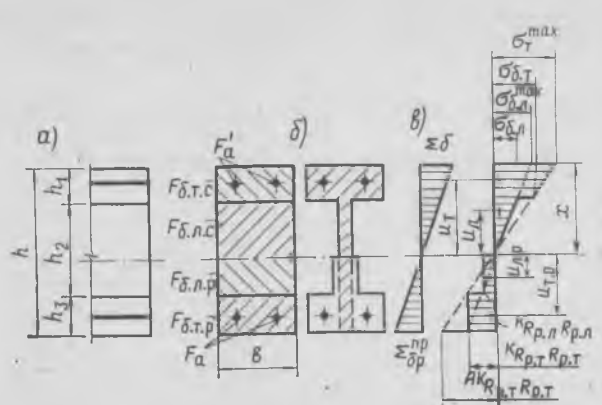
Схема (а) и расчетная эпюра напряжений трехслойного элемента перед образованием трещин с учетом продольной силы и неупругой работы бетона сжатой зоны при прохождении нейтральной линии в слое легкого (б) и тяжелого (в) бетона
